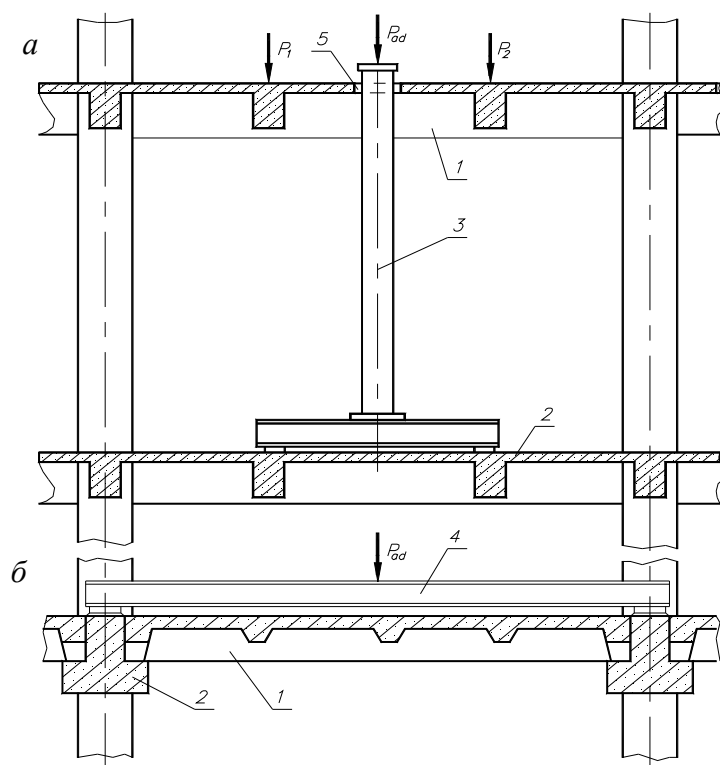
Полная передача дополнительной нагрузки на другие конструкции:
